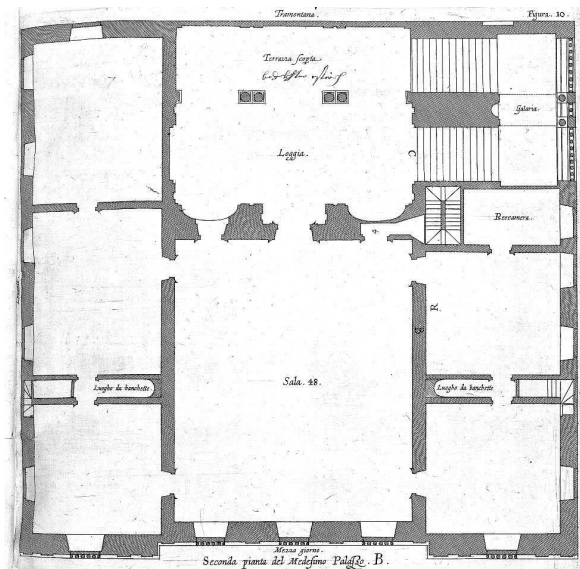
Seconda pianta del Medesimo Palazzo B, in RUBENS 1622.
